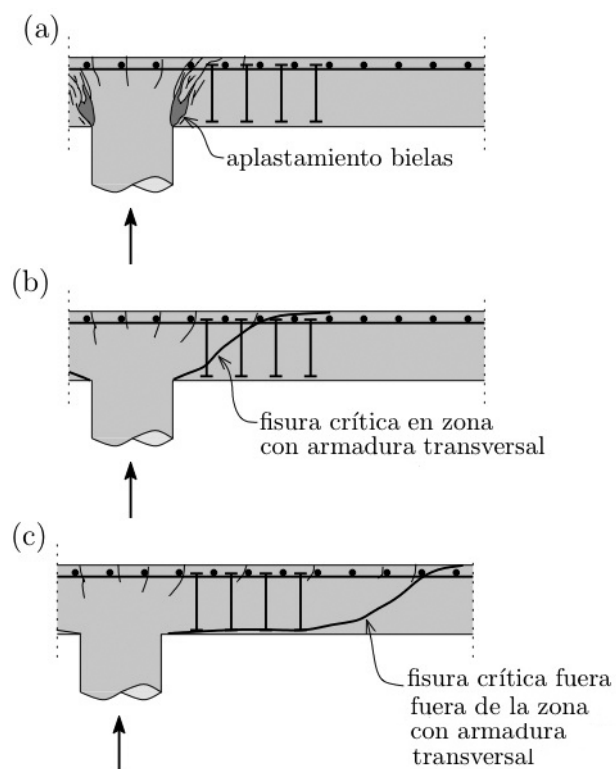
Modos de rotura en losas con armadura transversal: (a) aplastamiento de bielas; (b) punzonamiento con localización de deformaciones en la zona con armadura transversal; y (c) punzonamiento fuera de la zona con armadura transversal
